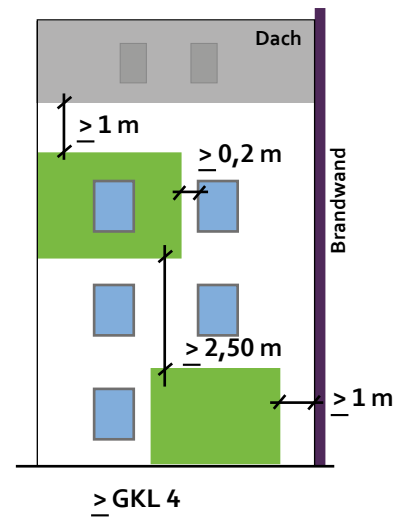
Mögliche Ausführungsvarianten bei wandbodengebundenen Fassadenbegrünungen gemäß [29]
